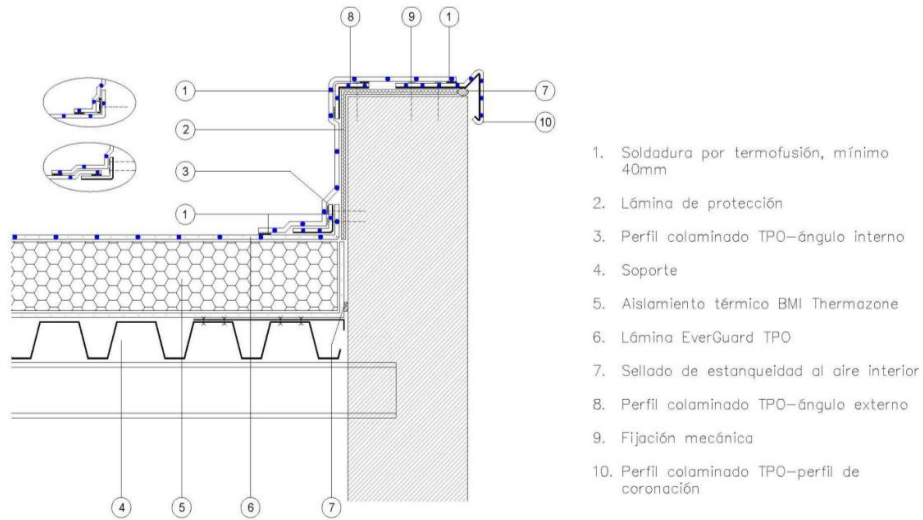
Remate peto perimetral no adherido con barra de fijación mecánica.
